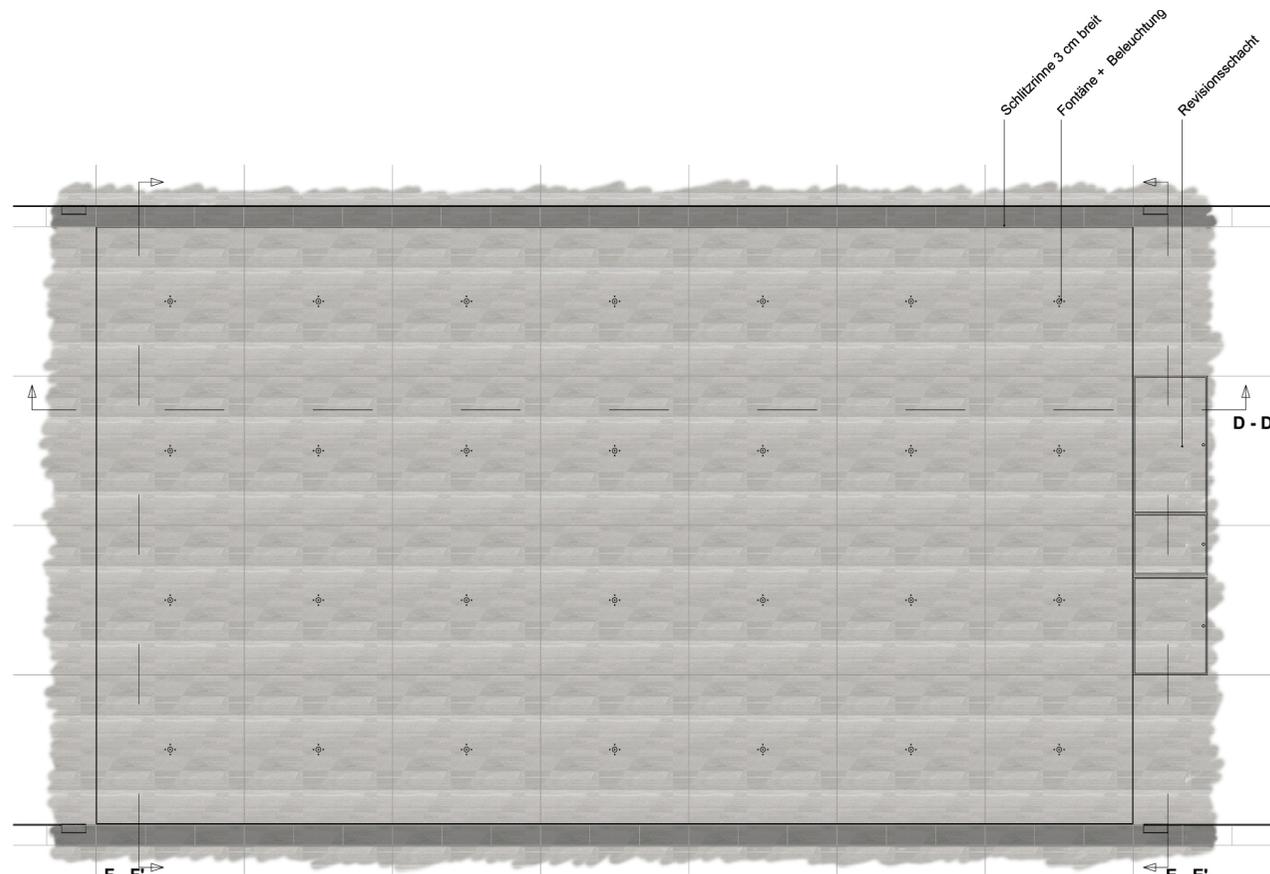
Wasserspiel sichtbare Elemente im Grundriss
